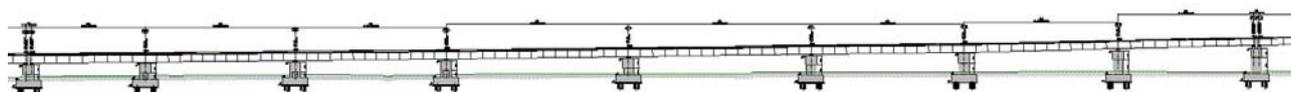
Sezione longitudinale tronco 2 carreggiata SX.
